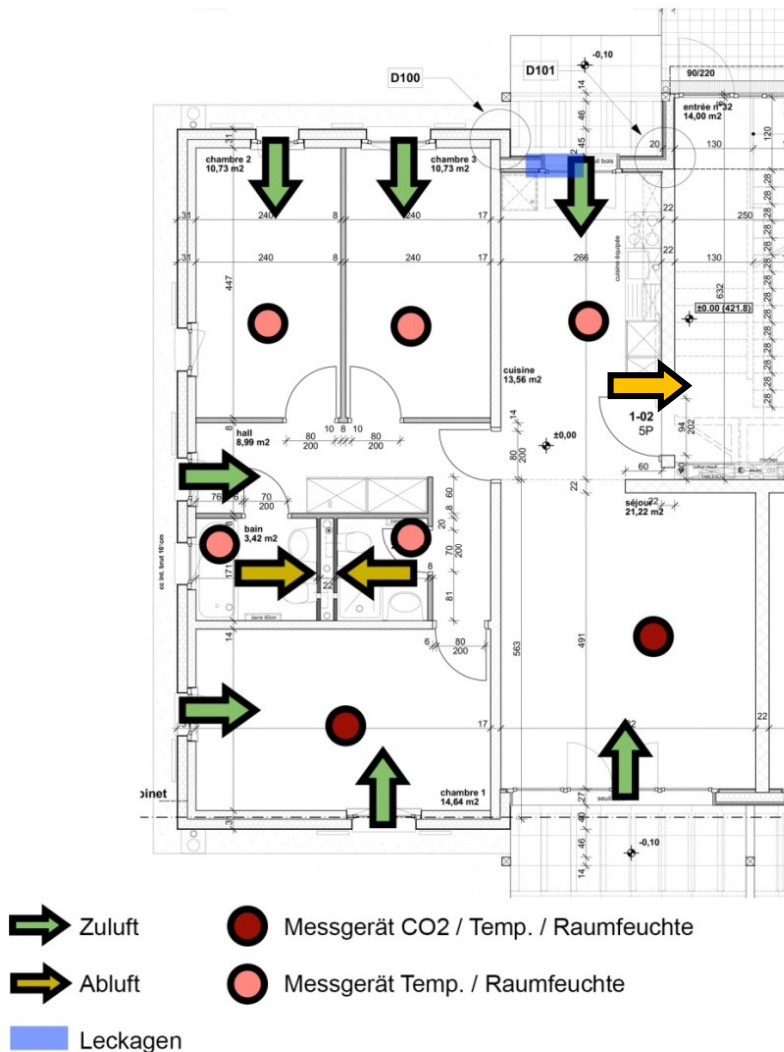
MFH Russin: Grundriss Wohnung F
